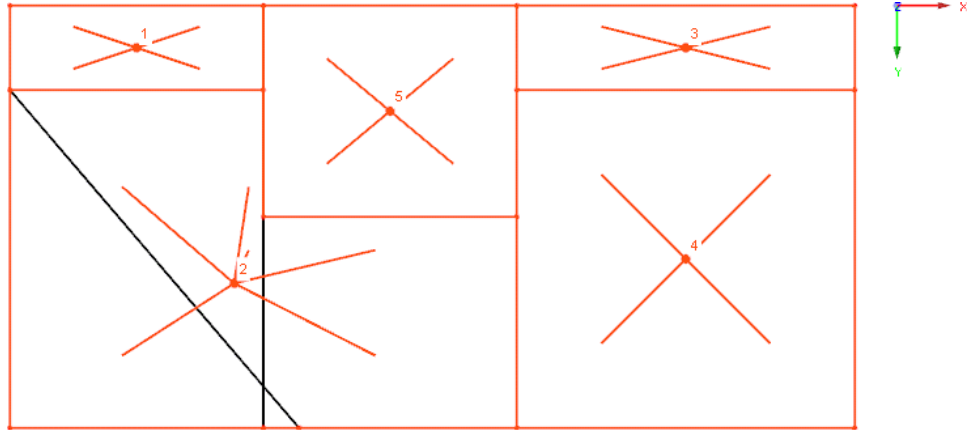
Construcción de plataforma con celdas para la generación de cargas
